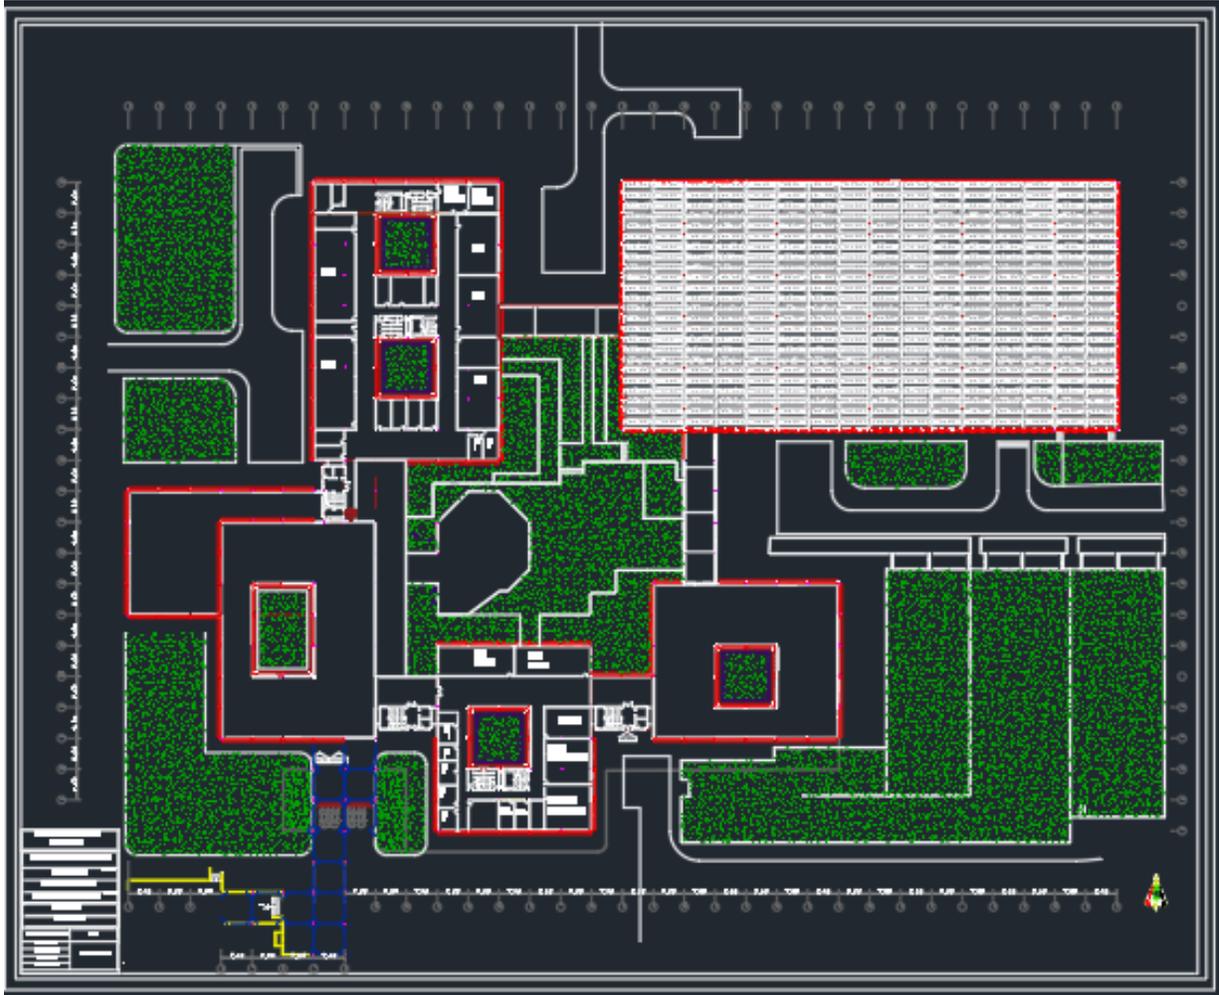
مسقط الطابق الثاني لكلية الهندسة
